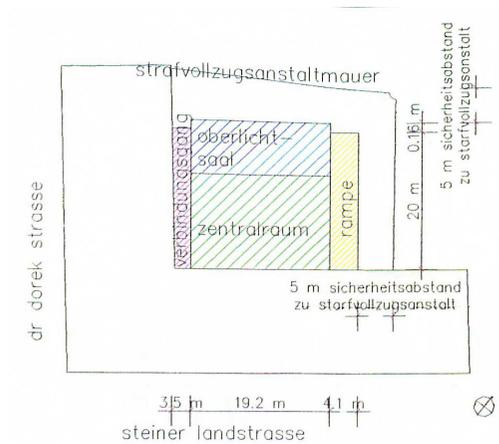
Grundriss Umbau zu Kunsthalle
